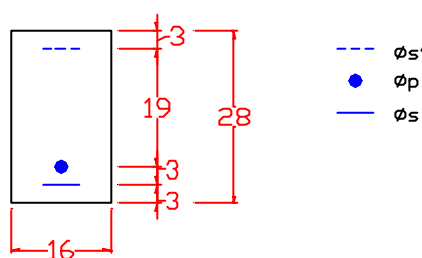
Seção das vigas A e D (cotas em cm)
